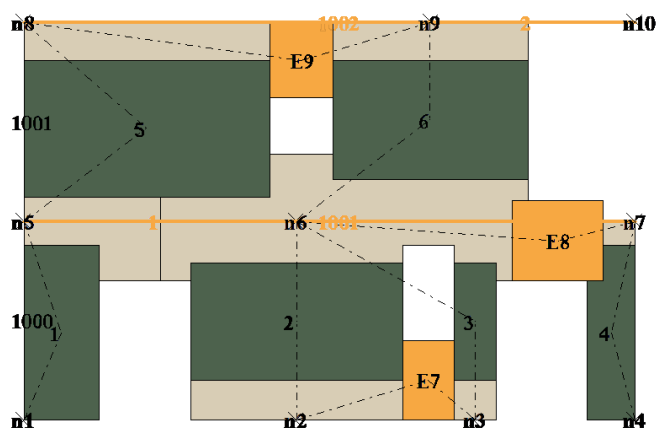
Prospetto Parete 1 - Modello Isolato singola parete
